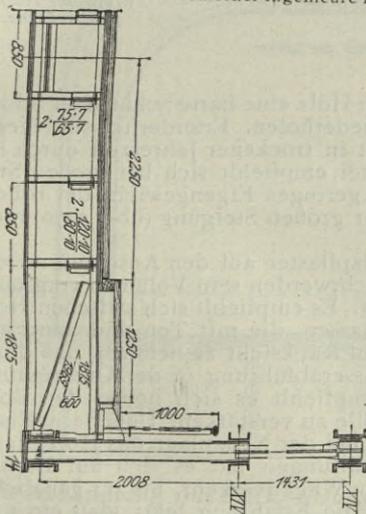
und 197. Querschnitte durch die Fahrbahn der Kaiser Wilhelm-Brücke in Wilhelmshaven. (Drehbrücke).
